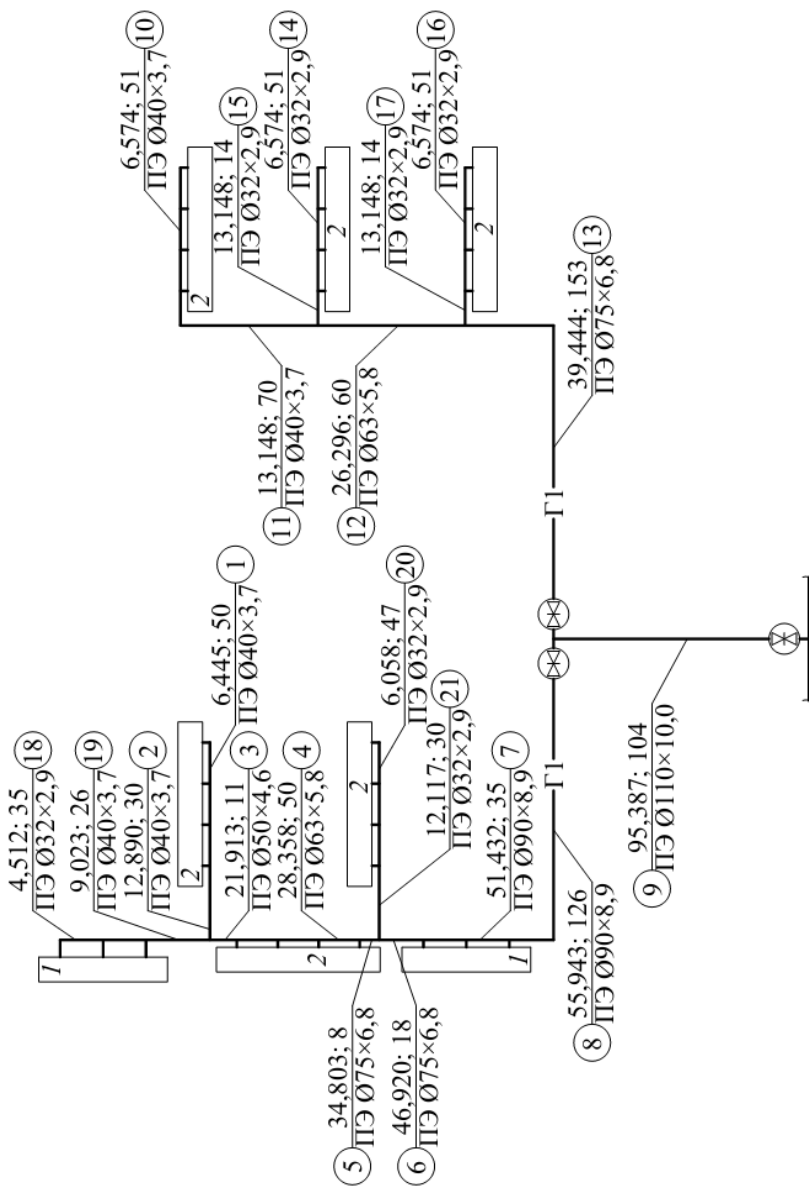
Расчетная схема внутриквартальной сети газопроводов низкого давления
